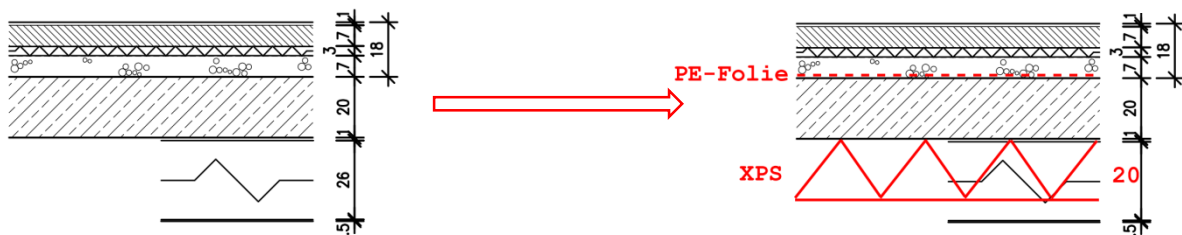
modifizierte Geschoßdecke unter Erdgeschoß - Links: Bodenaufbau unter EG real, Rechts: fiktiver Bodenaufbau unter EG, aus Anhang 1-2 Aufbauten Katalog
